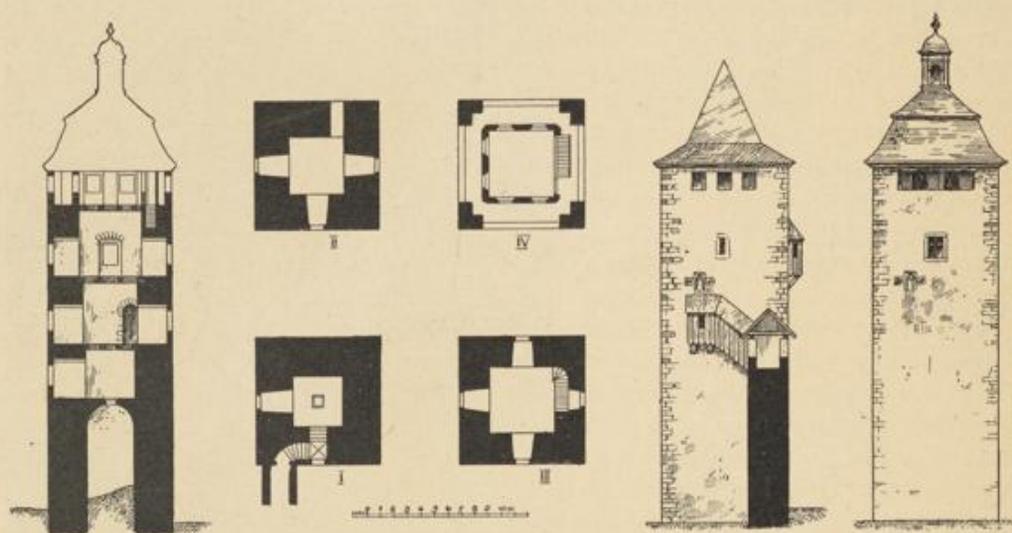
Grundrisse, Aufriß, Schnitt und Rekonstruktion des Berchfritz der Burg zu Bruchsal.
